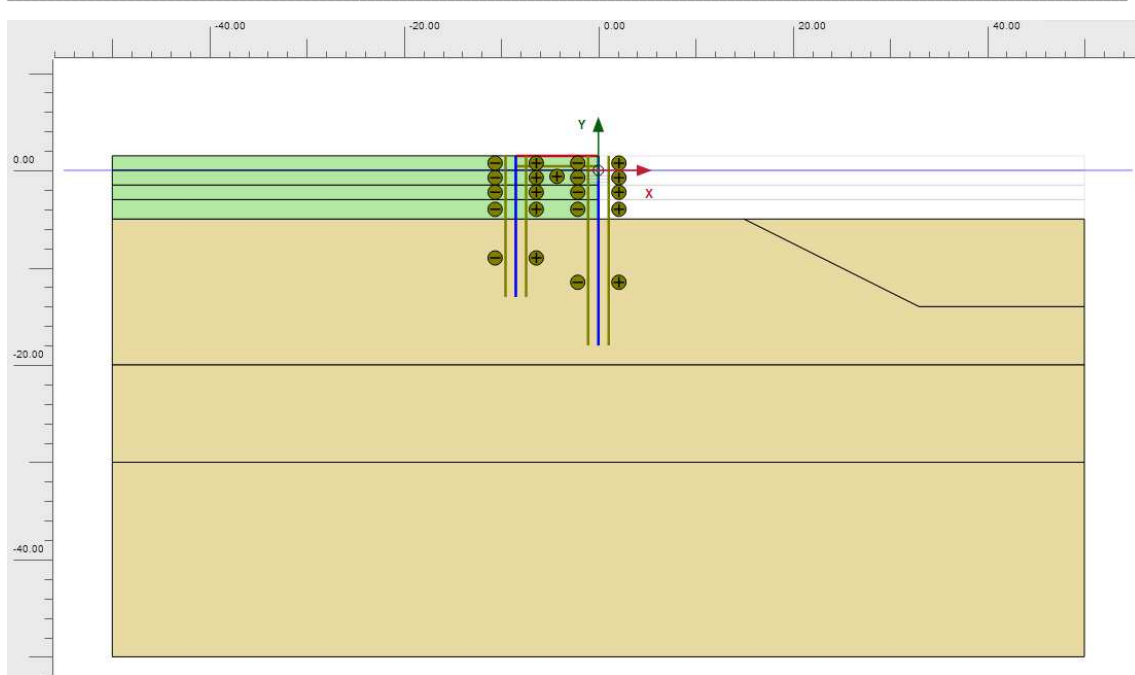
Fase 3 - Infissione paratia di ancoraggio e getto solettone
